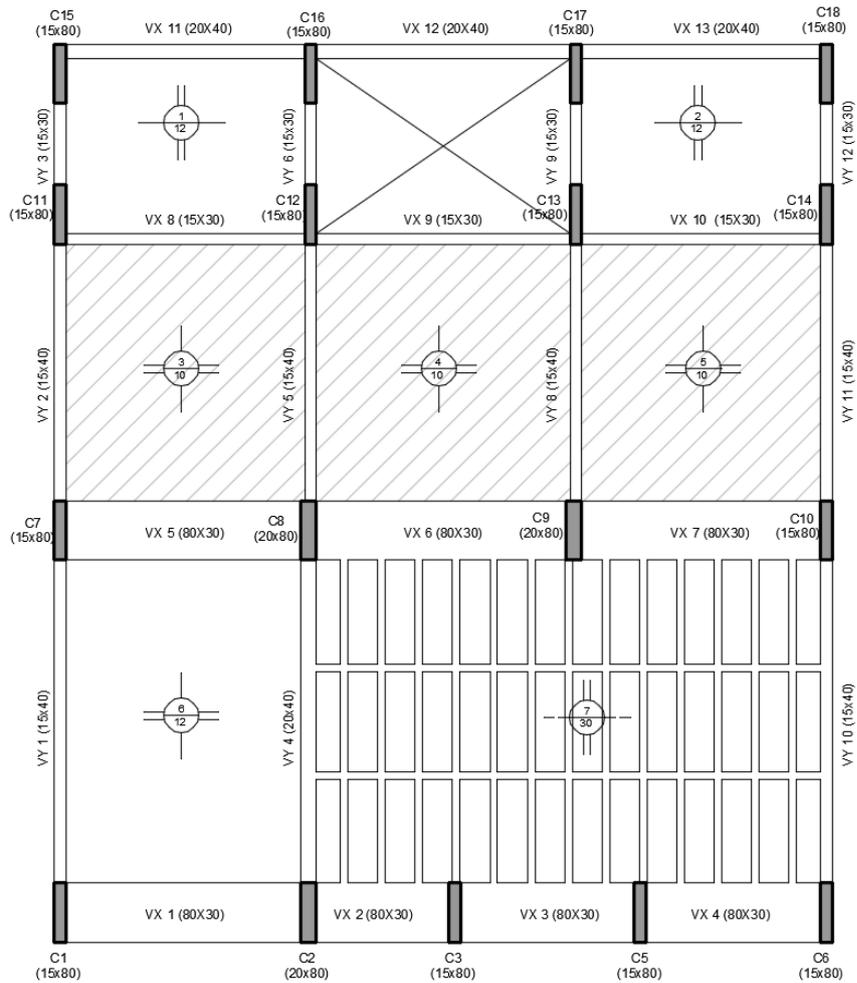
Planta de estructuras con losas macizas y nervuradas
